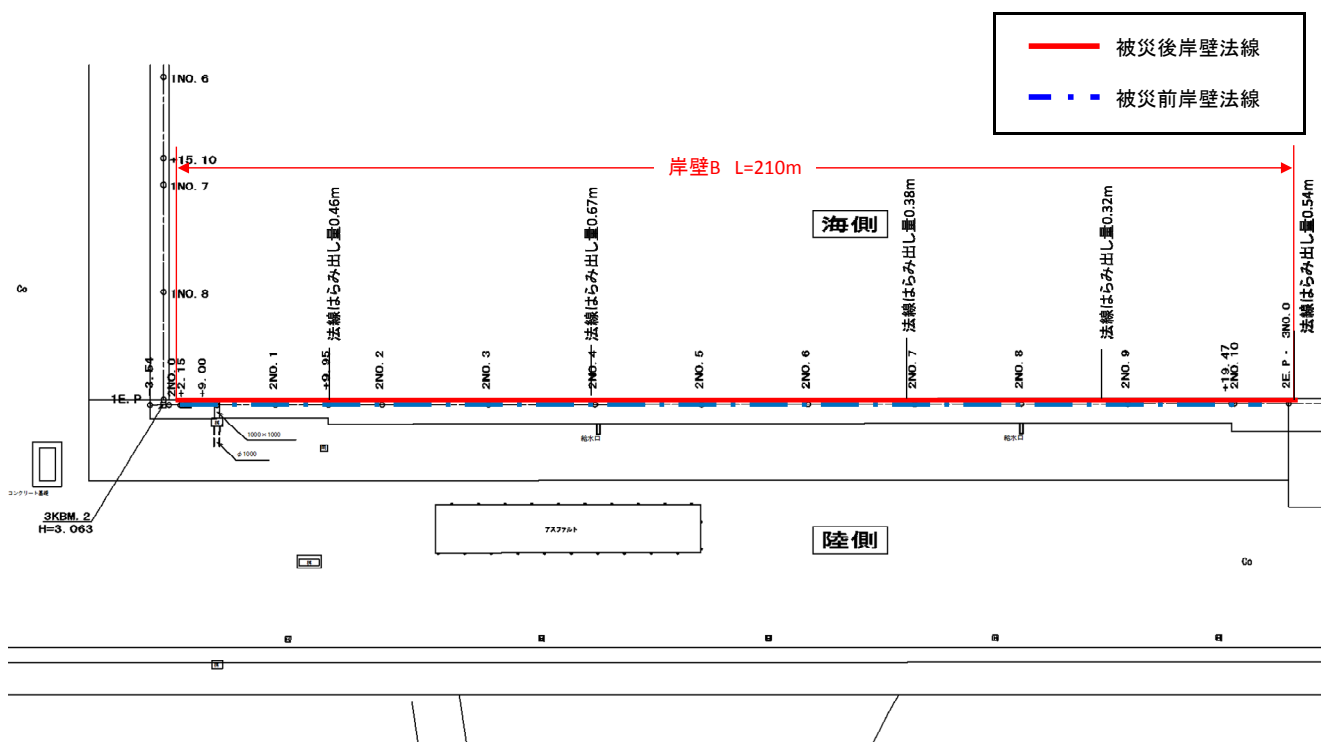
No.22 常陸那珂港区\_南埠頭地区 B 岸壁 (-5.5m) の平面図 (被災後)
